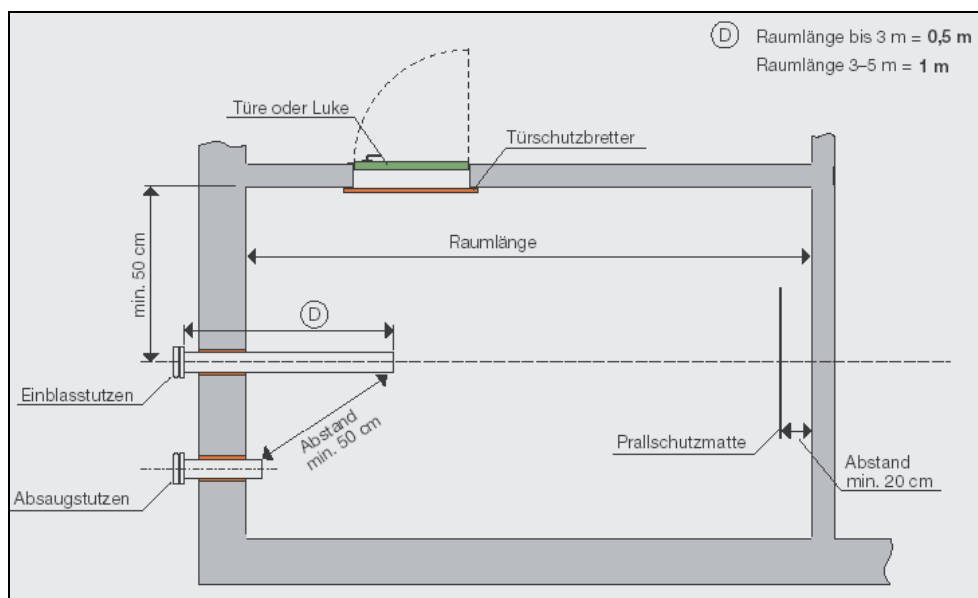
Grundriss eines Pellets-Lagerraums
